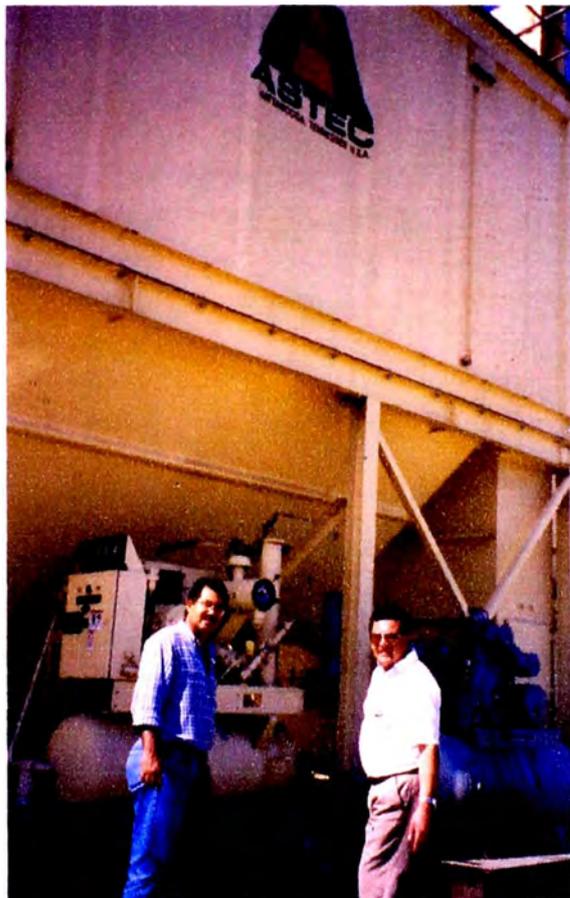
Inspección de las cimentaciones, tabiques y estructuras del baghouse de la planta de asfalto Double Barrel de la Empresa Tito Castro en PONCE PUERTO RICO
